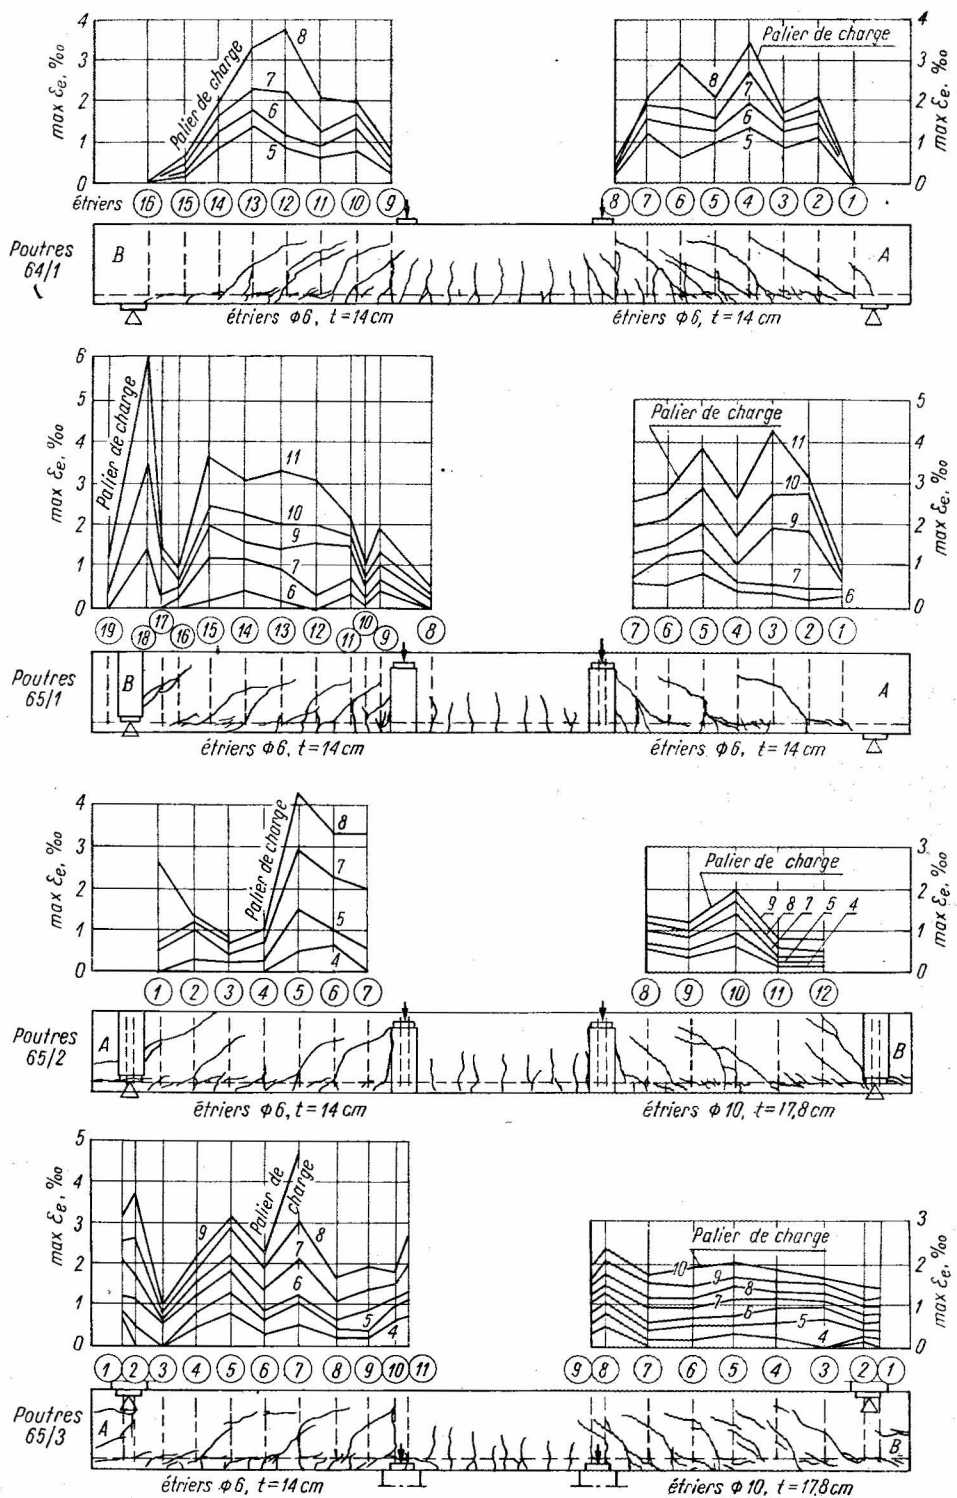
Fissuration et déformations des poutres 64/1, 65/1, 65/2, 65/3 au dernier palier de mise en charge
